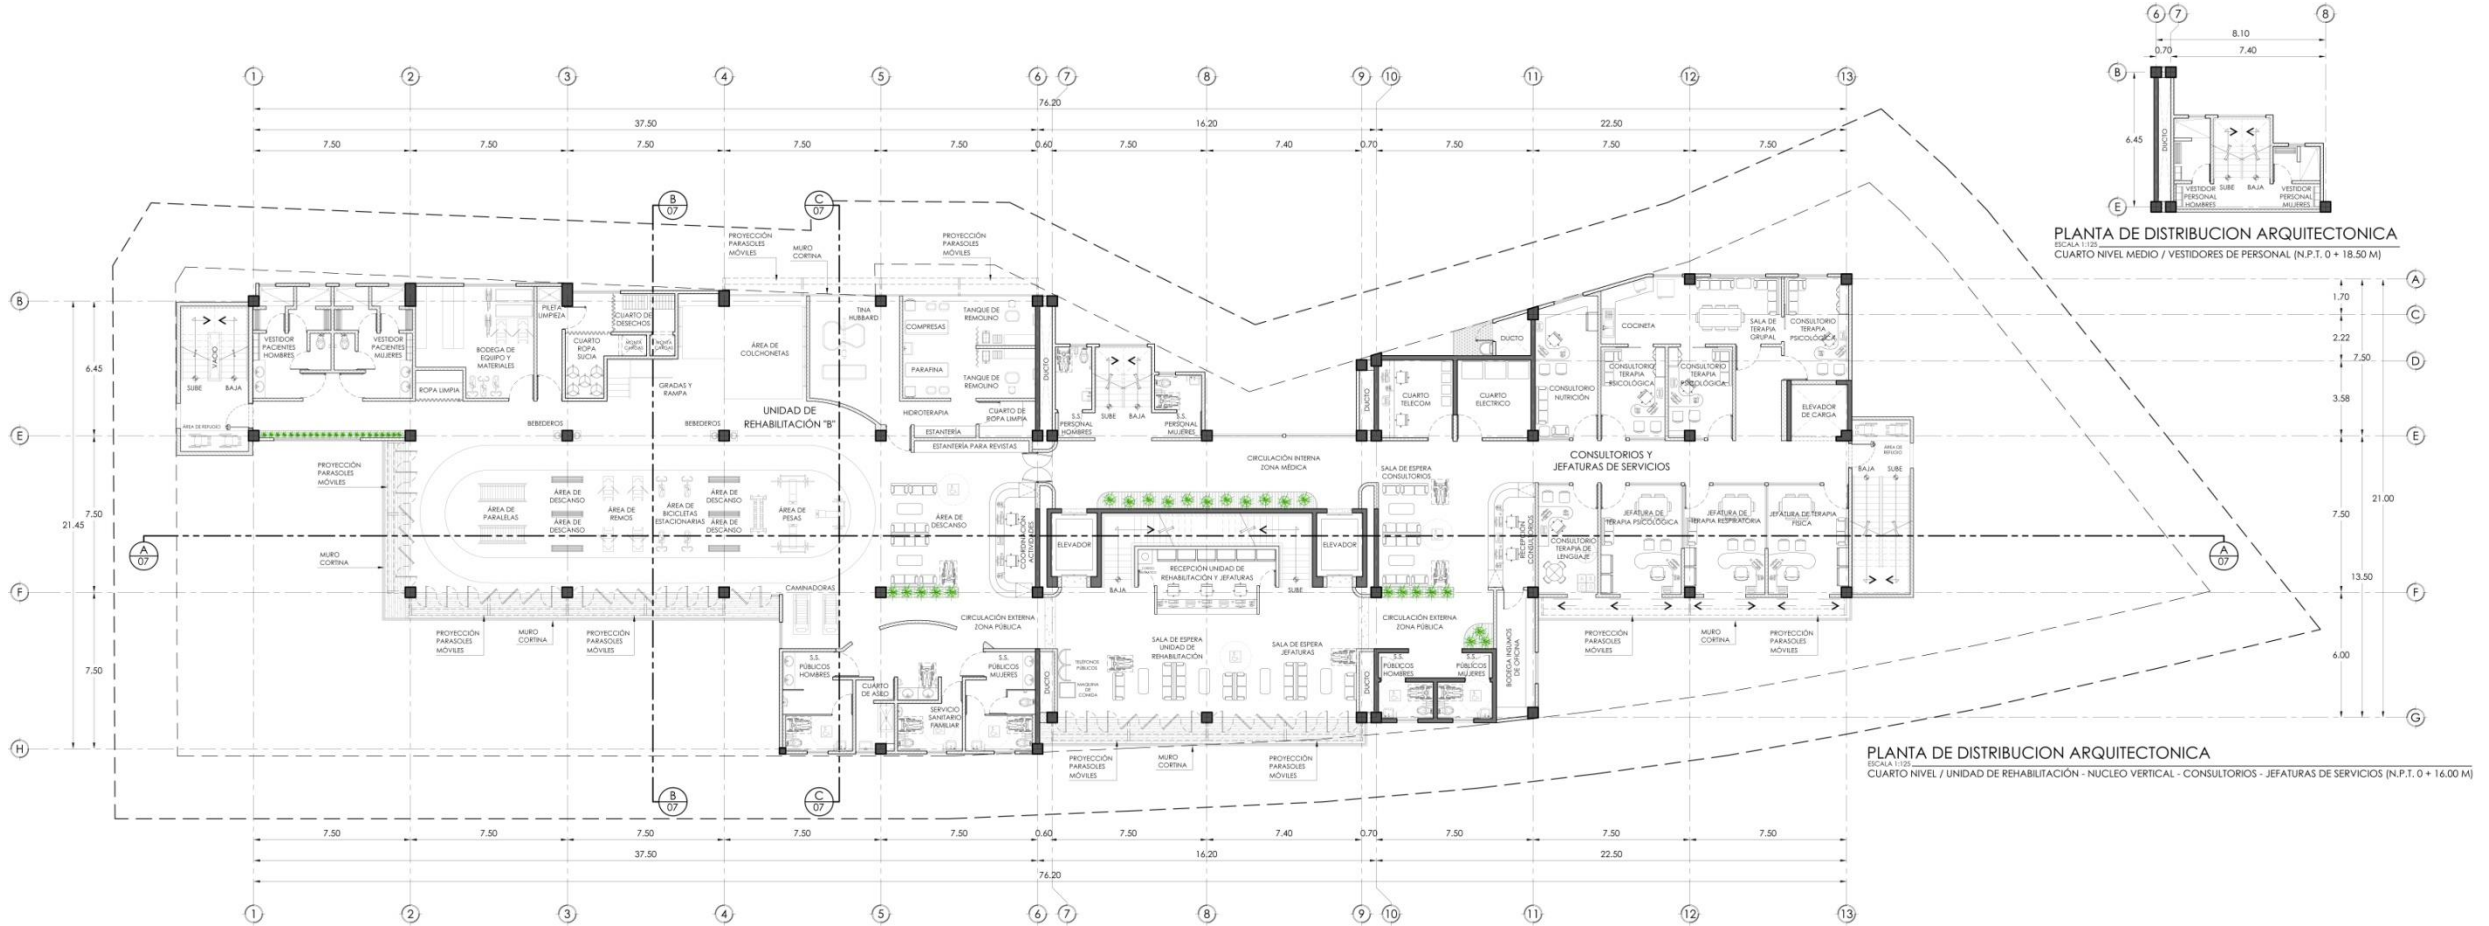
Planta Arquitectónica, Cuarto Nivel
